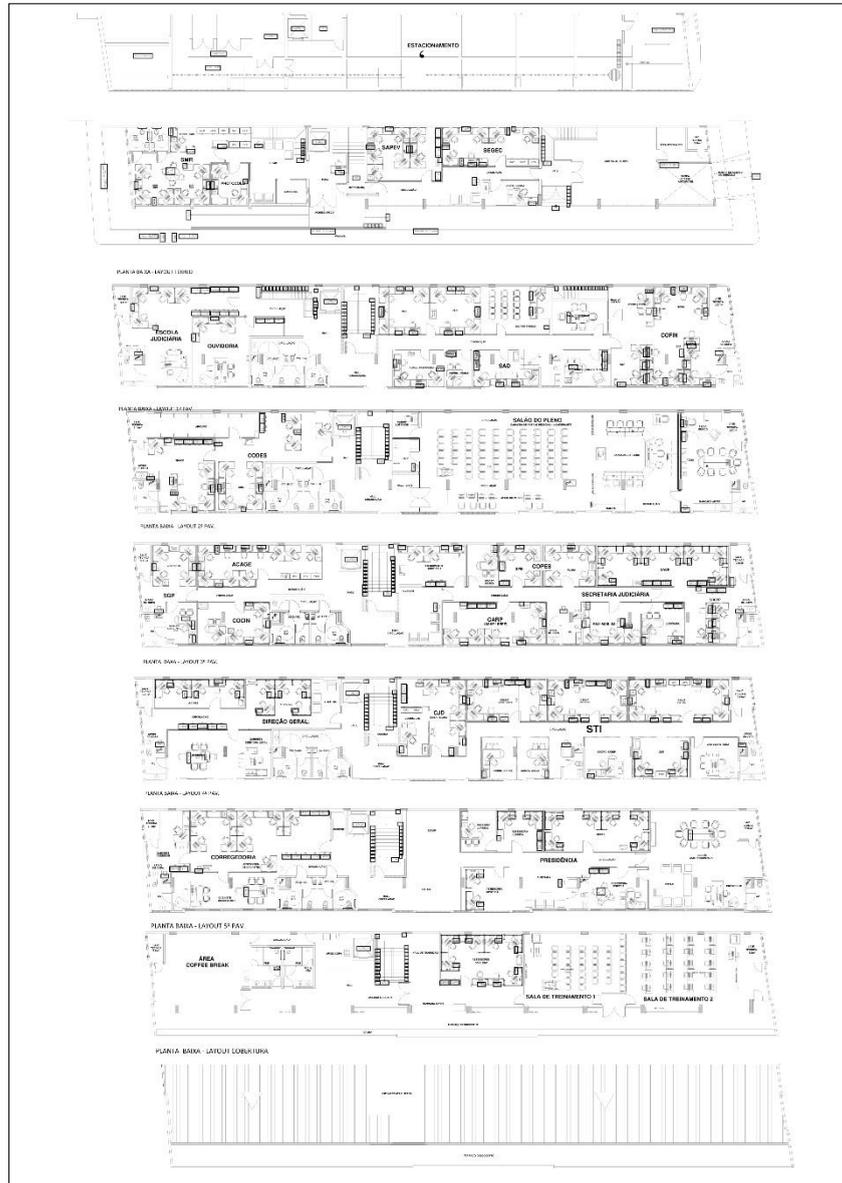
Plantas Baixas do Subsolo à Cobertura
